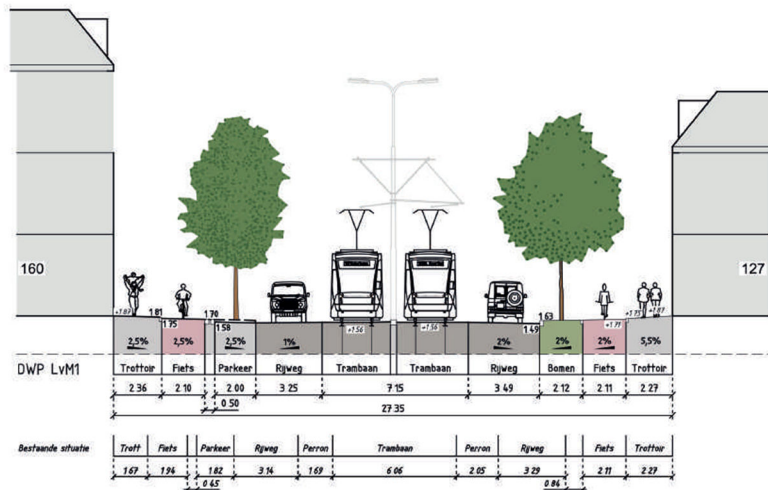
voorontwerp Laan van Meerdervoort bij Zoutmanstraat
